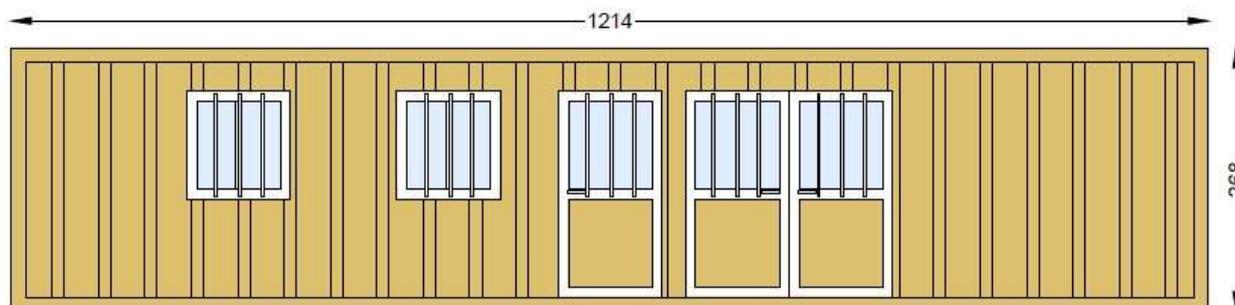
Prospetto tipico di una Control room – misure in cm
